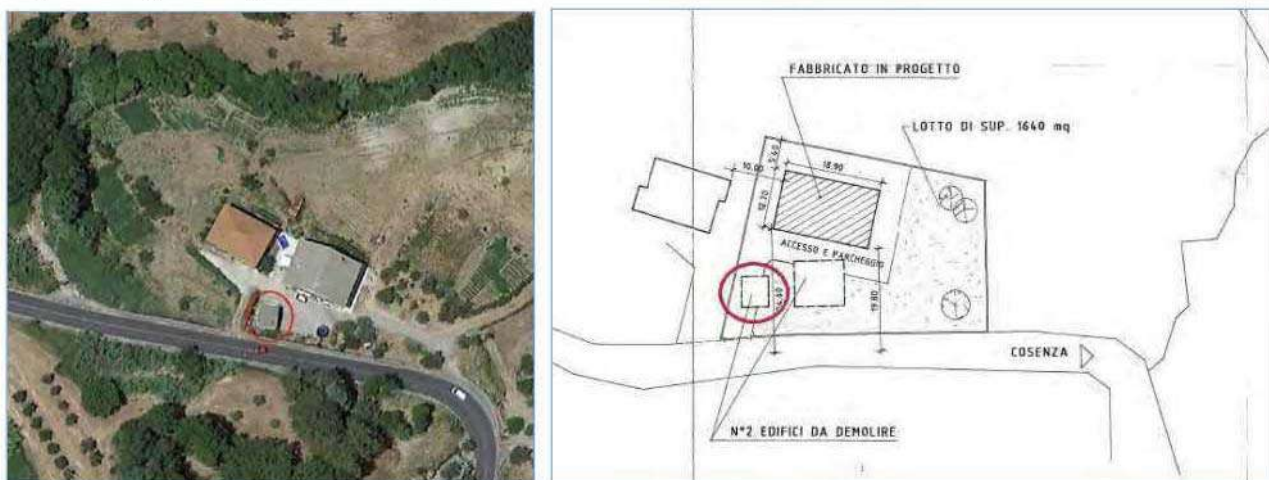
Individuazione su ortofoto e su disegni di progetto delle piccole strutture situate all'interno del lotto
